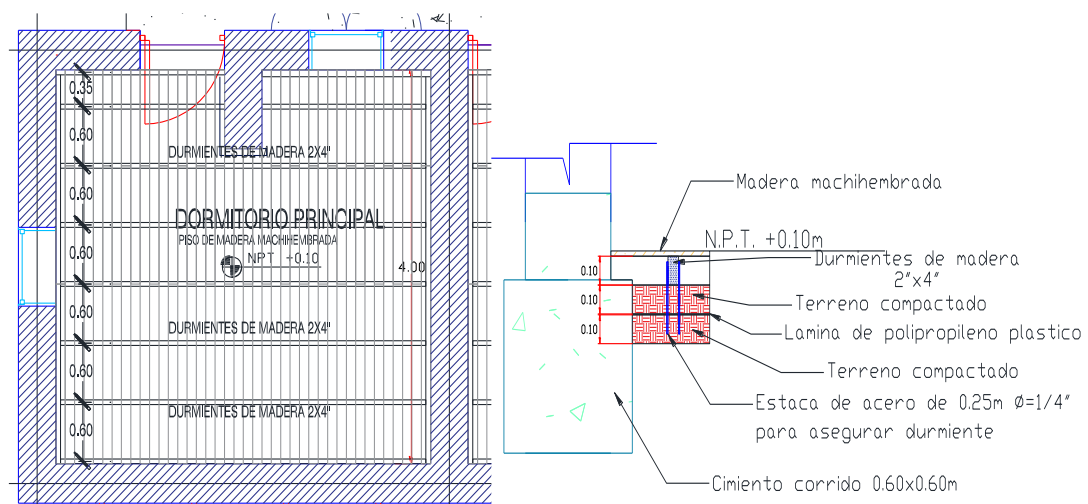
Vista en planta y sección de detalle de piso machihembrado
